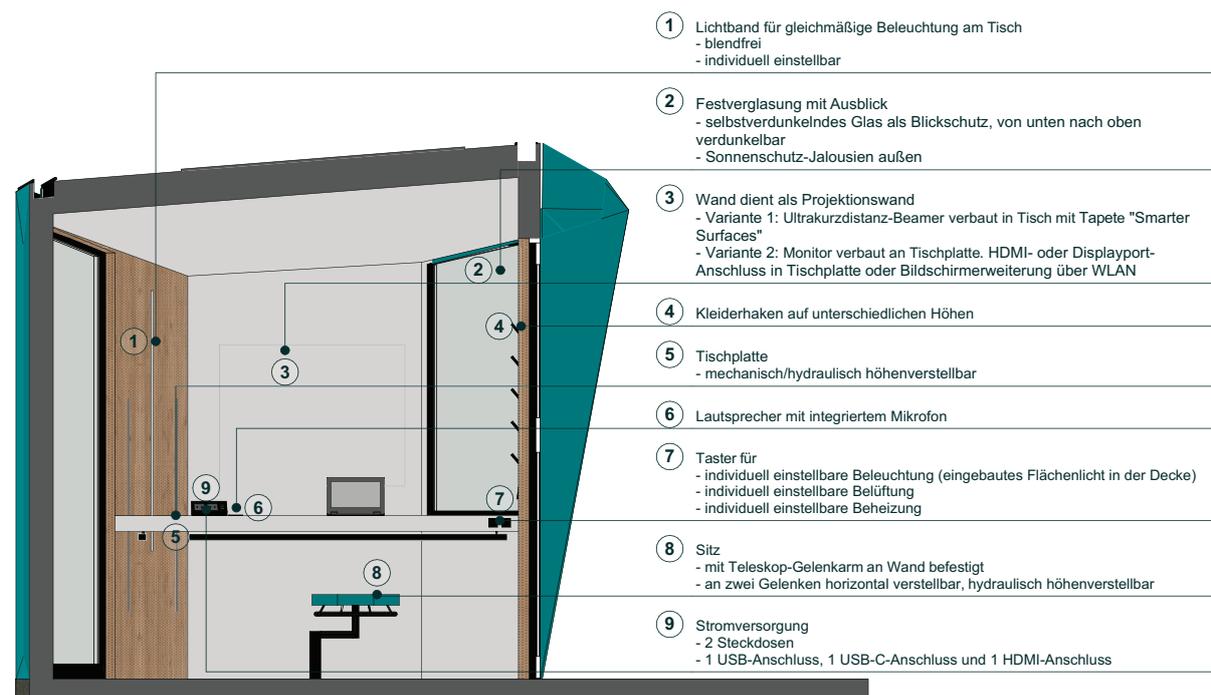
Grundriss der *Walk-In-Box
